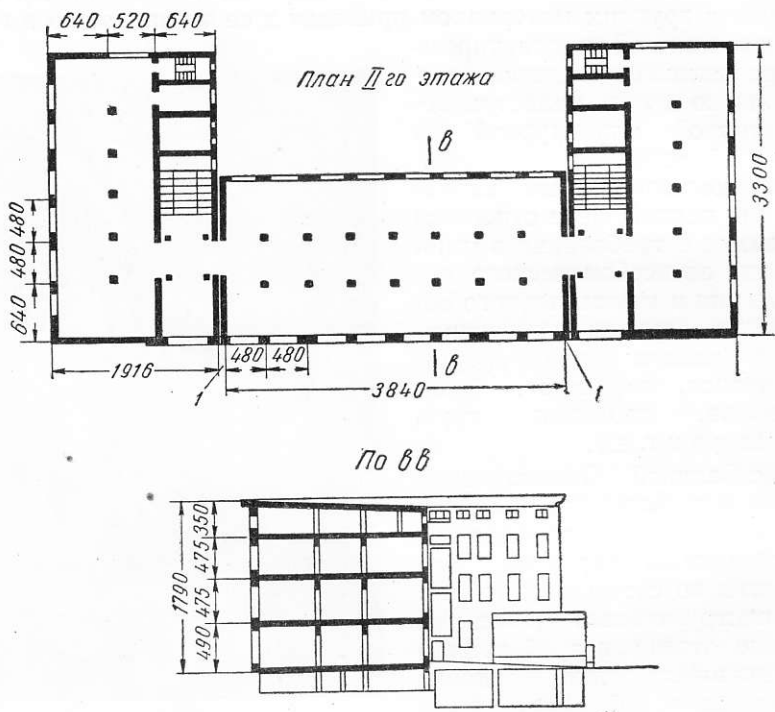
План и разрез универмага, строящегося с монолитным железобетонным каркасом
